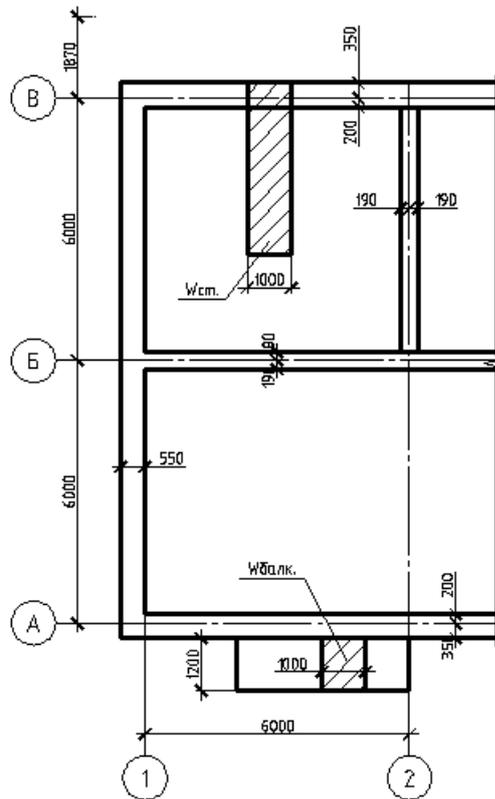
Грузовая площадь стены до реконструкции
